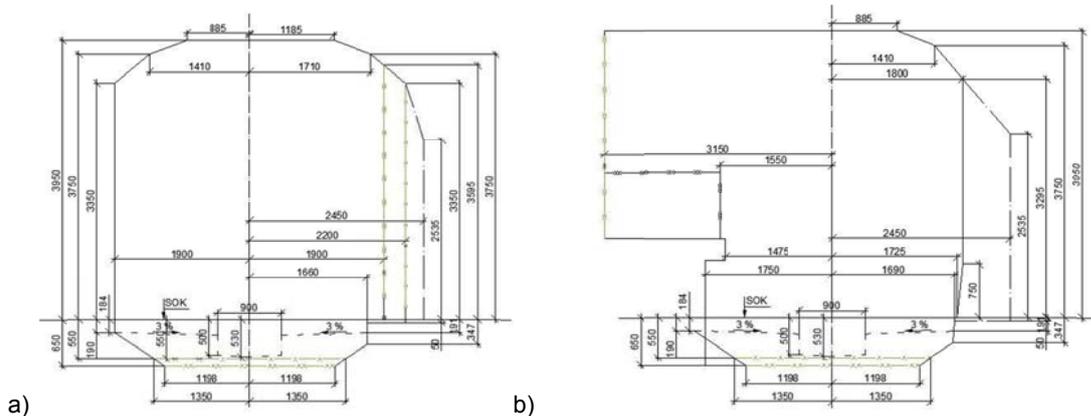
Lichtraumprofil<sup>20</sup> - a) Tunnelstrecke; b) Station
